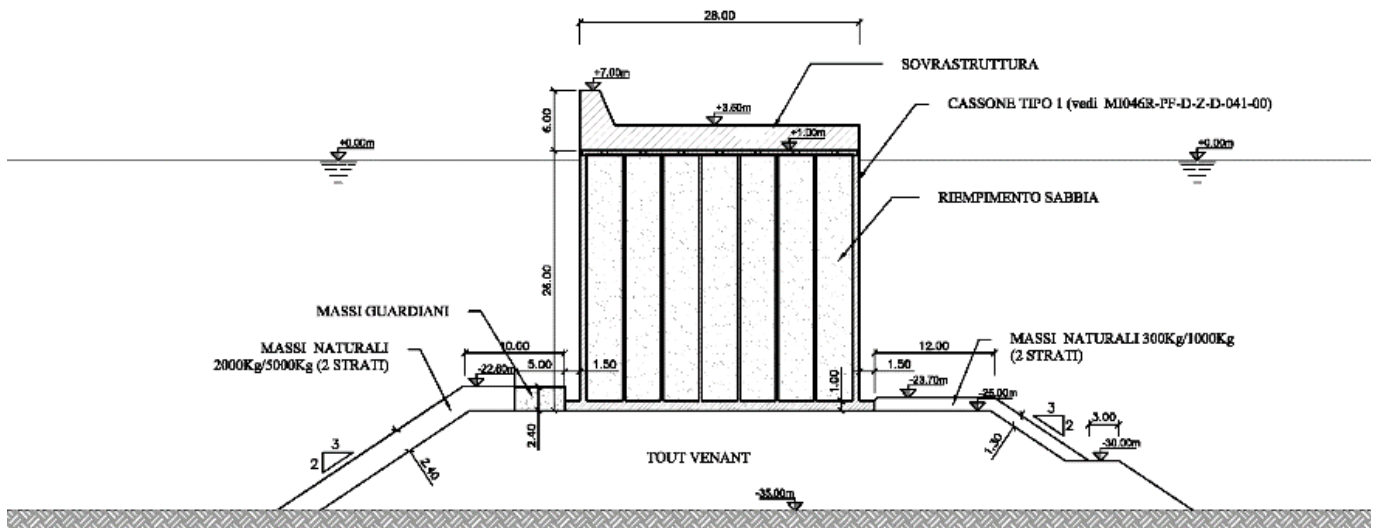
TIPOLOGIA COSTRUTTIVA A PARETE VERTICALE
